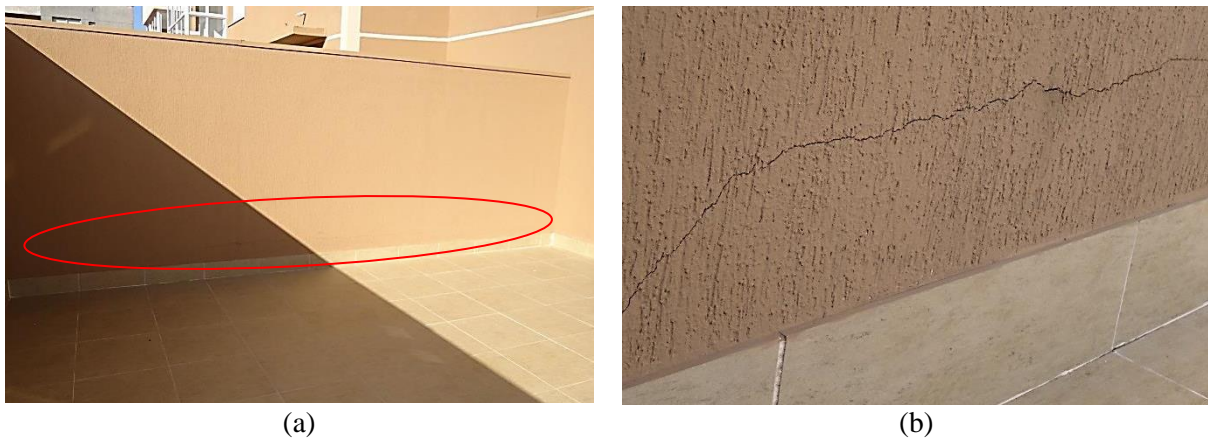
(a) Parede do dormitório com presença de fissura e
